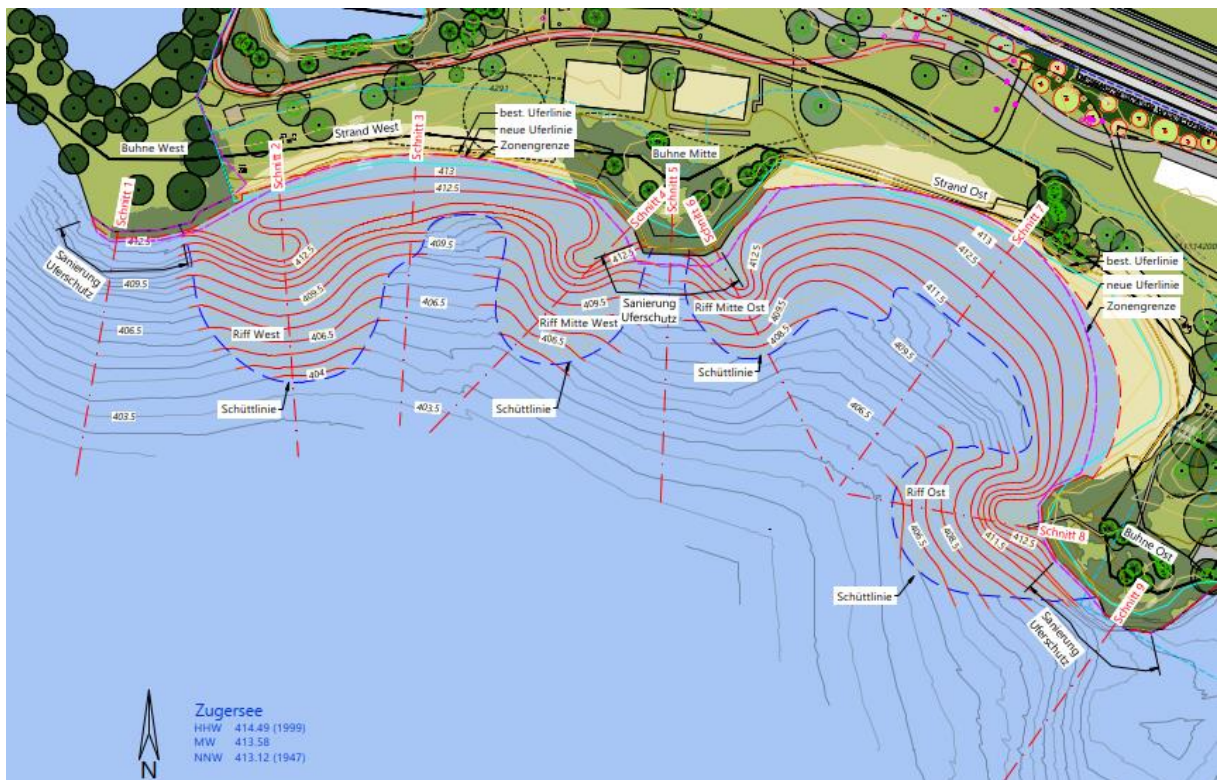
Situationsplan geplante Schüttungen, Stand Bauprojekt (August 2024)
